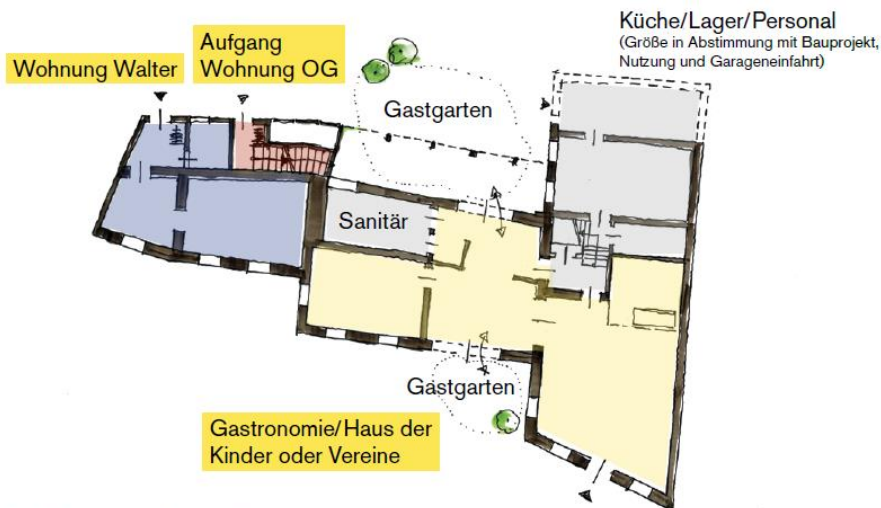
Bauplan Kirchenwirt mit Umbauarbeiten der 1940 Jahre (Architekturbüro nonconform, 2017)
